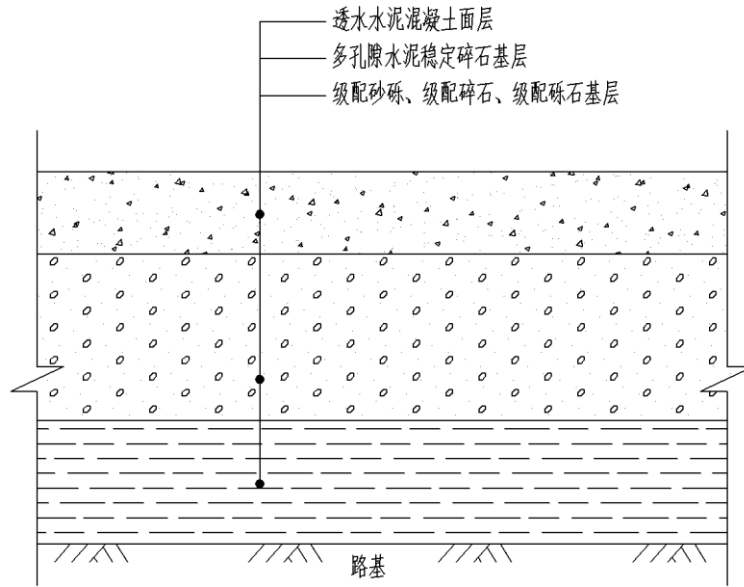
全透式透水水泥混凝土非机动车道、停车场、广场路面结构示意图
